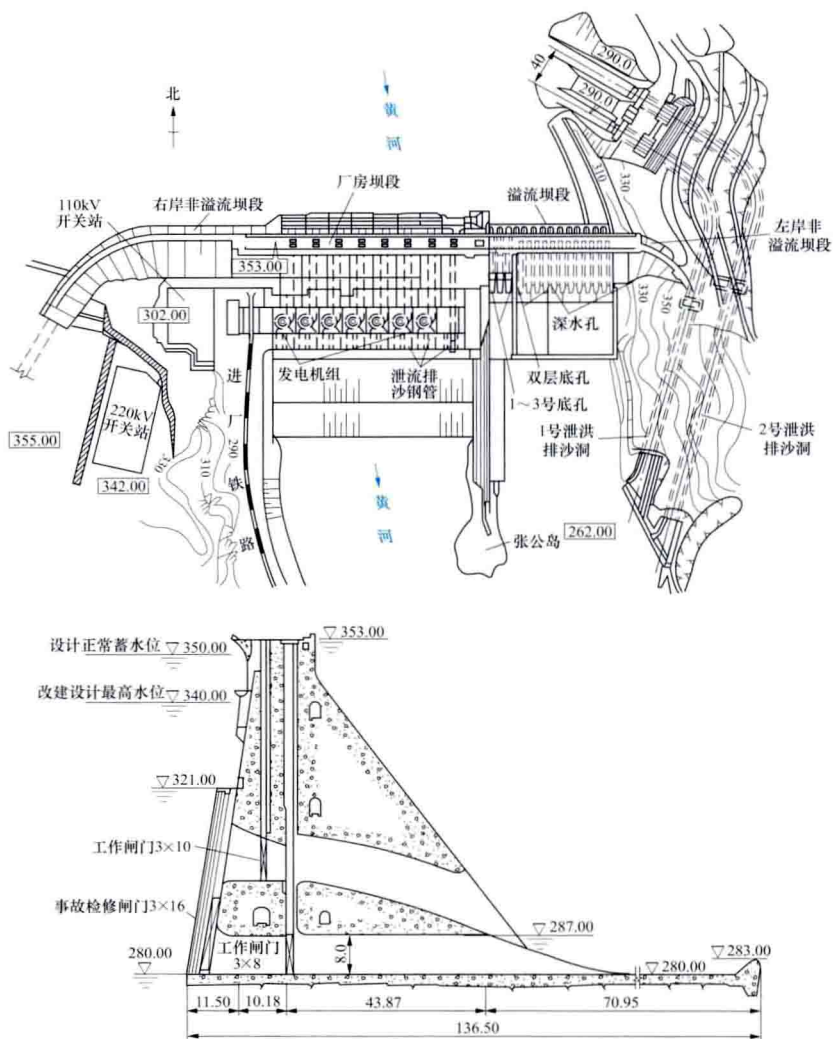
三门峡水电站枢纽平面布置及大坝剖面图(单位:m)
